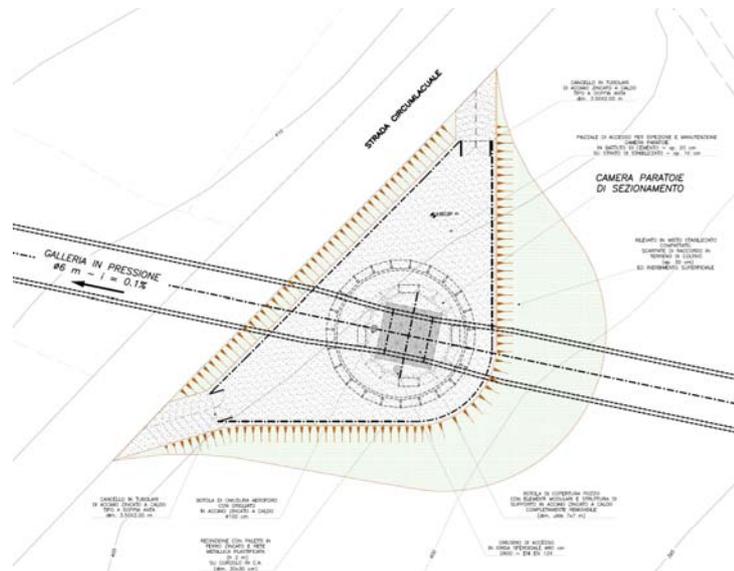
g: Stralcio Planimetrico Piazzale di Accesso al Pozzo Paratoie di Valle
